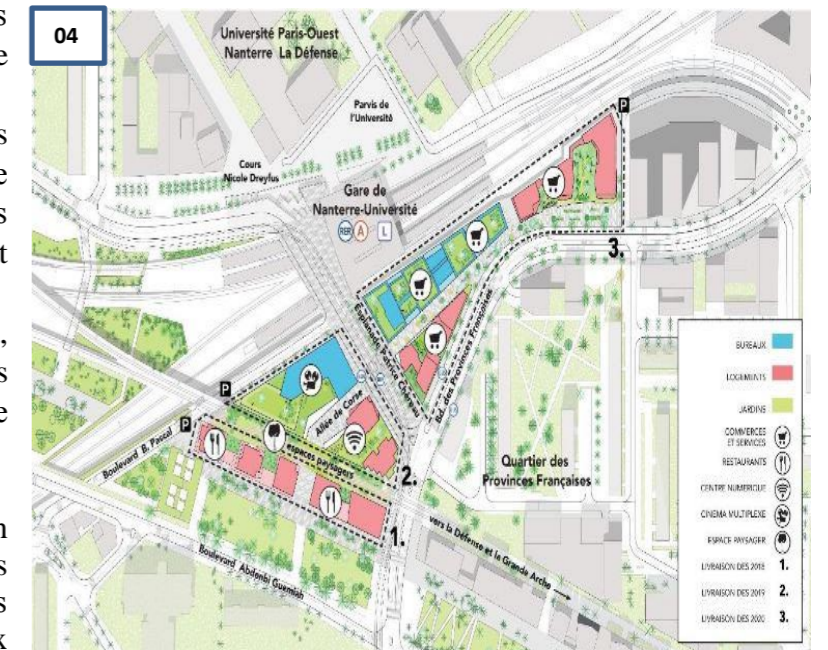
illustre un plan de masse de quartier De cœur d'Université, Le site est située dans le prolongement des Terrasses, à deux pas de la Défense, et s'inscrit dans un secteur en plein renouveau urbain. Le quartier s'étend sur une emprise de 76'000 m2 est constitué de quatre blocs séparés par deux rues piétonnes qui se croisent sur une place centrale. Il comprend 27'000 m2 de surfaces commerciales et bureaux et 35'000 m2 de surfaces résidentielles, et se caractérise par une organisation de l'espace sur plusieurs niveaux.
